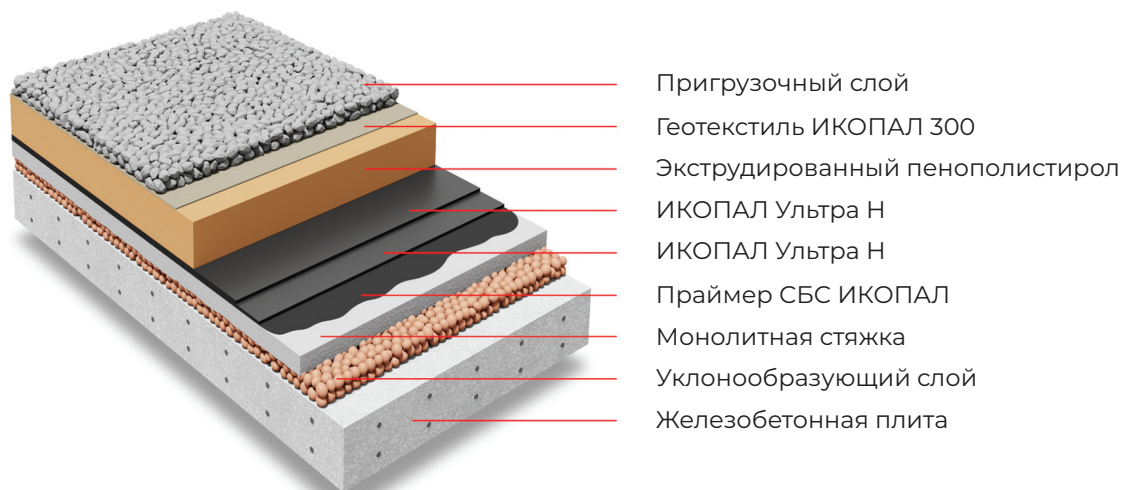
Вариант инверсионной неэксплуатируемой кровли с двухслойным кровельным ковром
